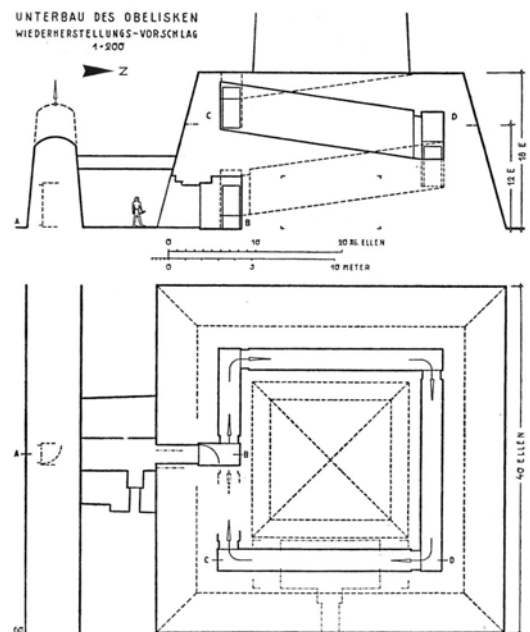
Grundriss/Schnitt Obelisk Sonnenheiligtum Userkaf
